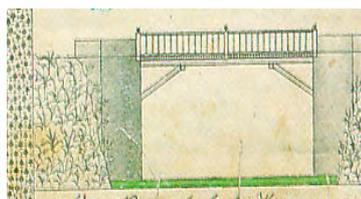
Santa Marta, elevação da ponte da estrada de acesso
